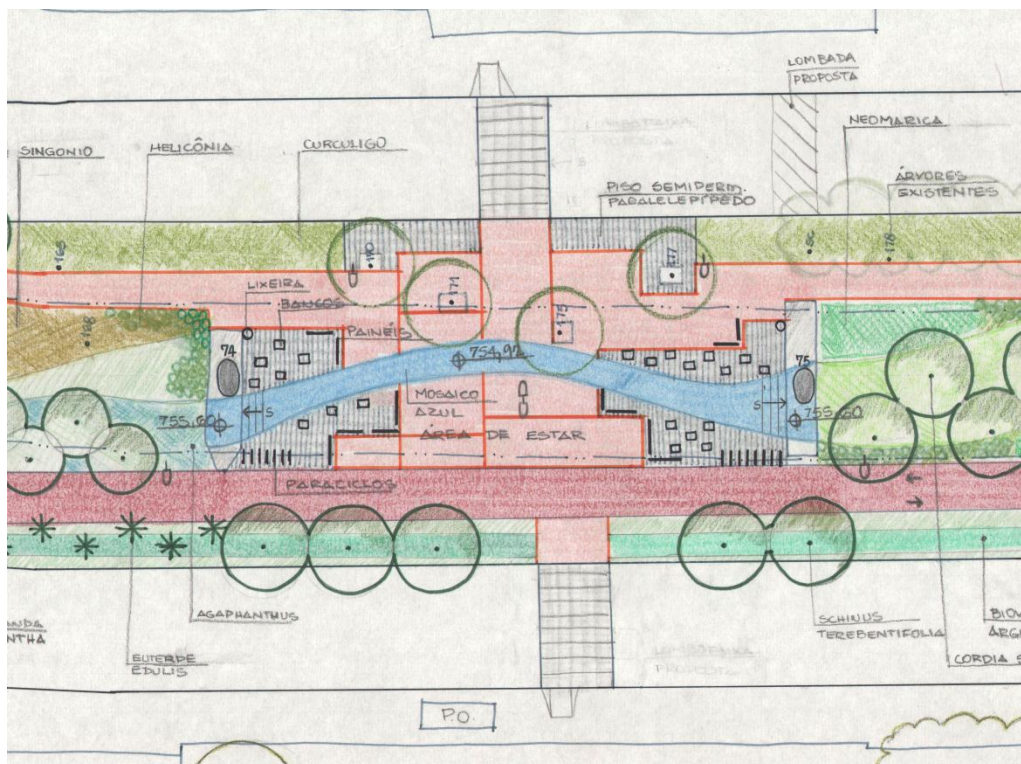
Proposta da Área com Painéis Informativos entre pilares 74/75
